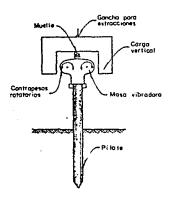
A.6.-PILOTE HINCADO CON VIBRACION
